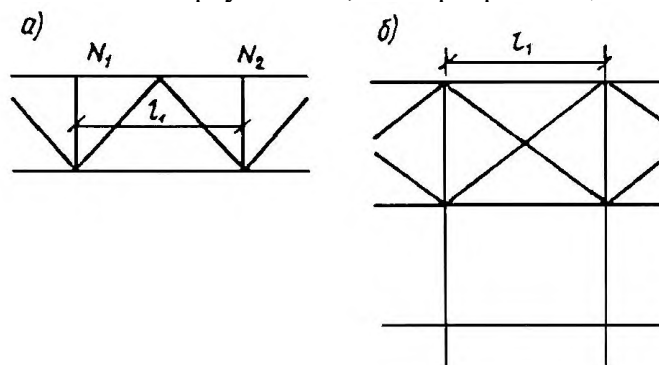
Схемы для определения расчетной длины пояса фермы из плоскости
